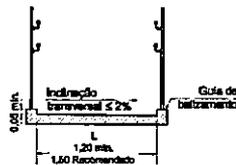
Inclinação transversal e largura de rampas - Exemplo
